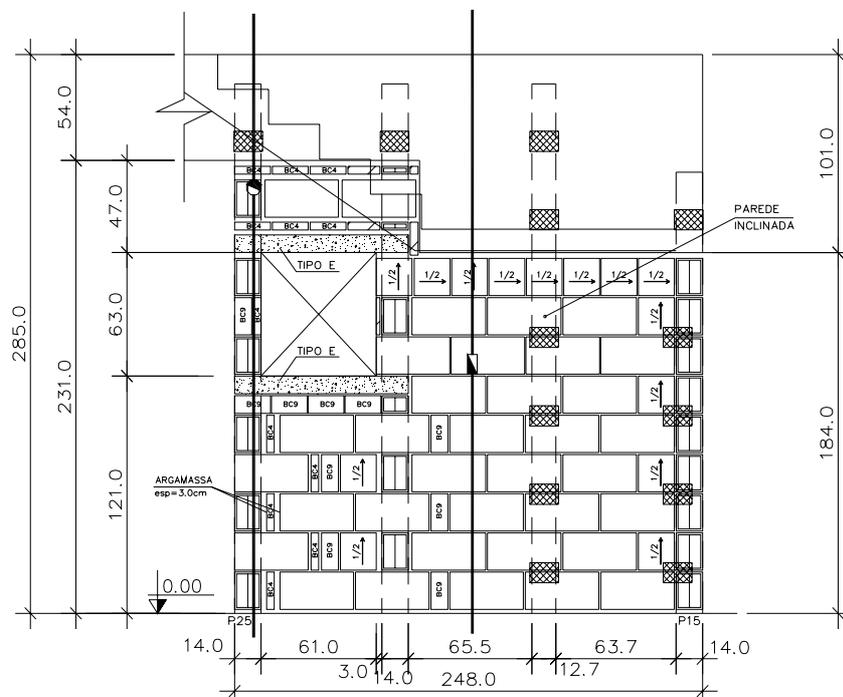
Elevação da parede lateral na entrada da escada revisada pelo projeto de vedação para o 9° ao 17° pavimento.
